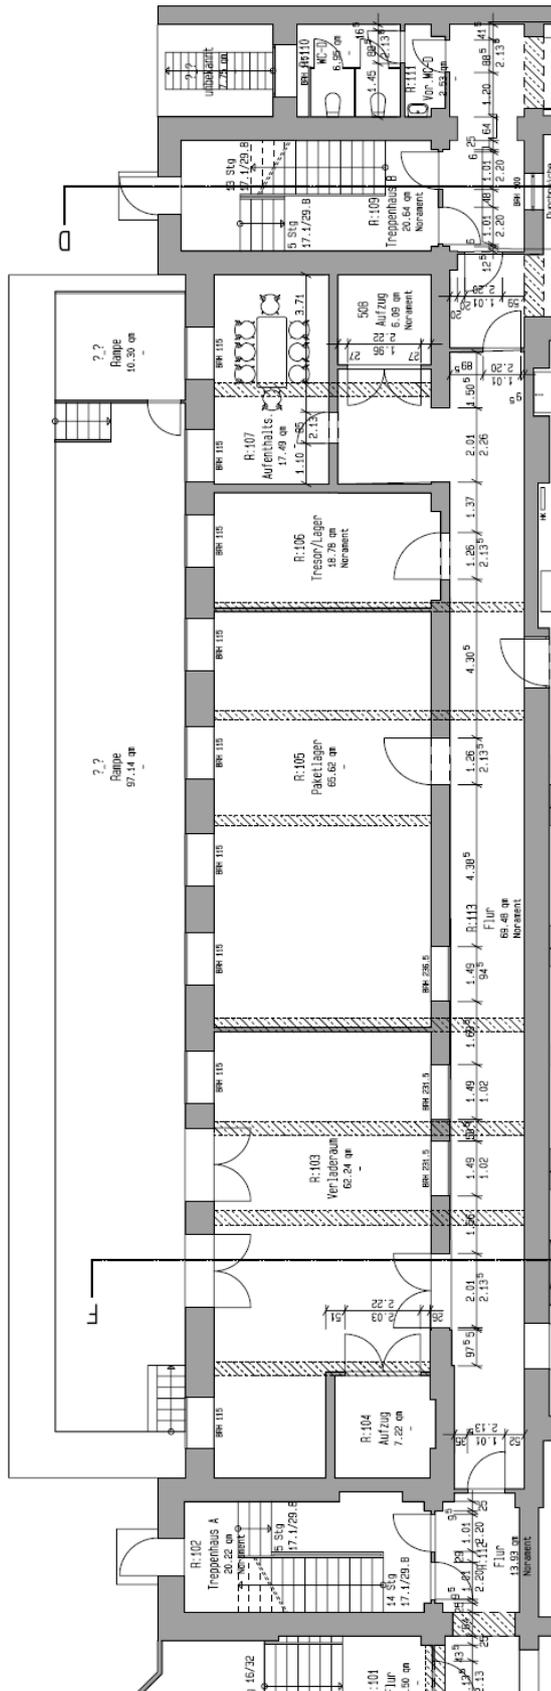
Objekt Krefeld im Grundriss
